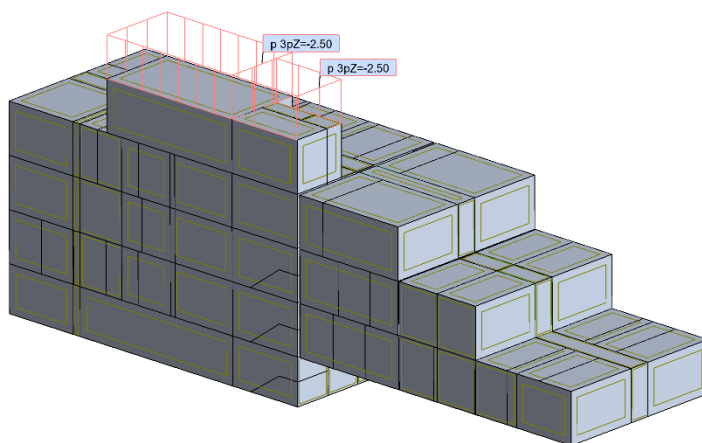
Przypadek obciążenia użytkowego od dachu ekstensywnego
